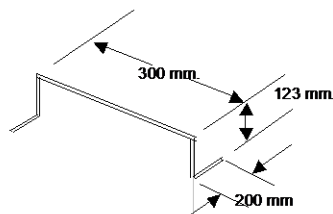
Diagrama de la colocación de la tubería en "U" del presfuerzo.
